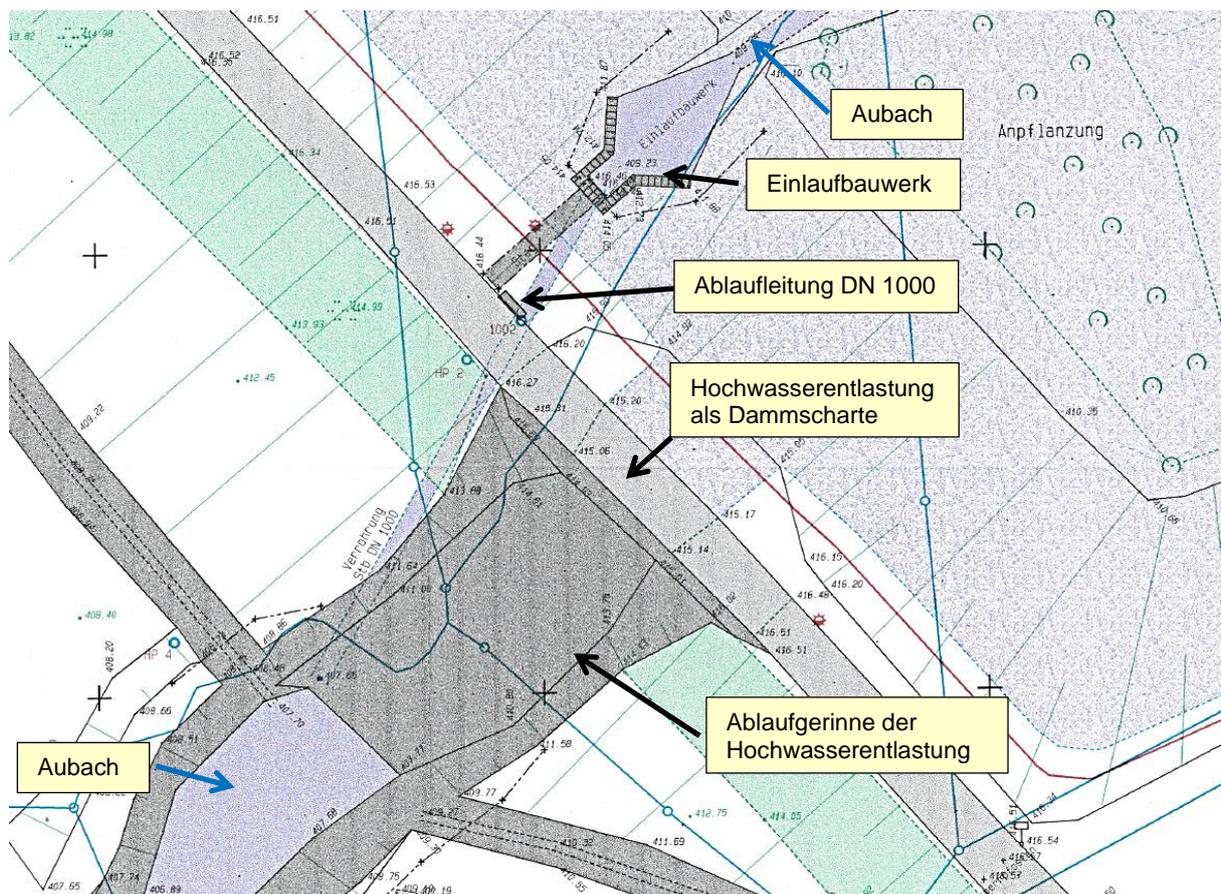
Ausschnitt Lageplan Bestand aus dem Jahr 1998
